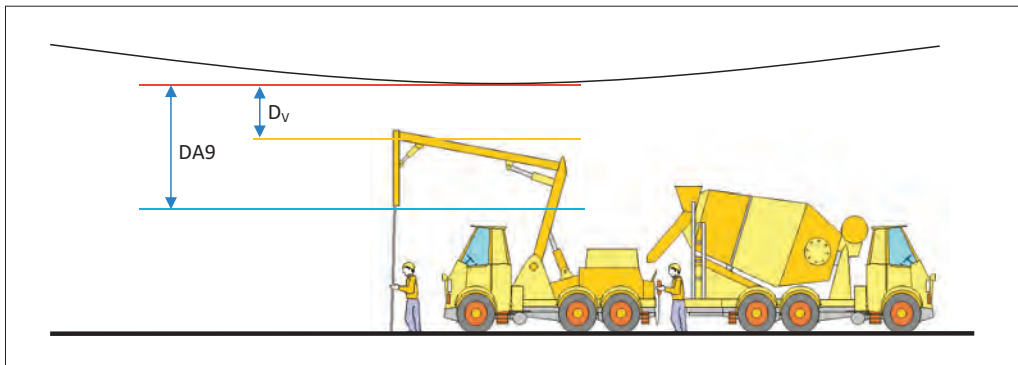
Betoniera e pompa per calcestruzzo autocarrata con lavoratori in situazione di pericolo.
